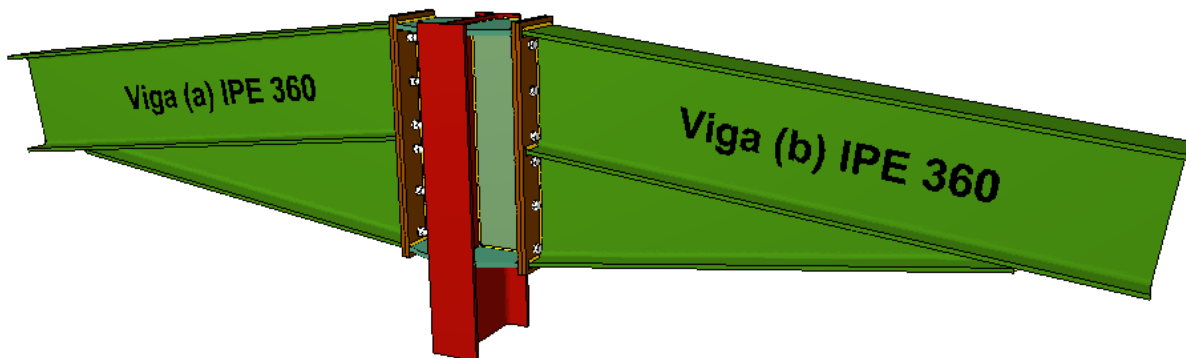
Detalle de la unión en CYPE 3D de Pilar de fachada – dos Jácenas.
